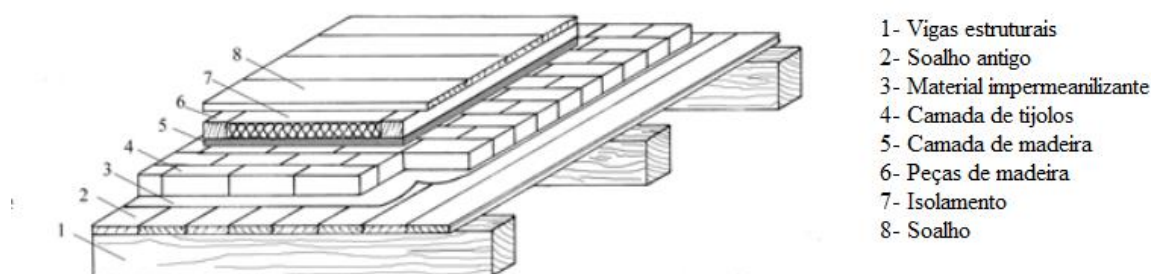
Exemplo de reabilitação e reforço de pavimentos elevados (Nachwachsende, n.d.)
